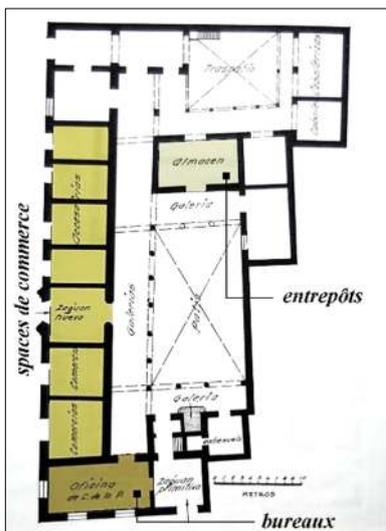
Weiss Joaquin, Rez-de-chaussée, maison de Calvo de la Puerta, Plan de levé (en jaune) il est signalé par l'auteur les nouvelles fonctions commerciales des espaces dans la maison traditionnelle havanaise. Source : Illustration tirée de : Weiss Joaquin, *La arquitectura colonial cubana*, Letras Cubanas, 1979.
